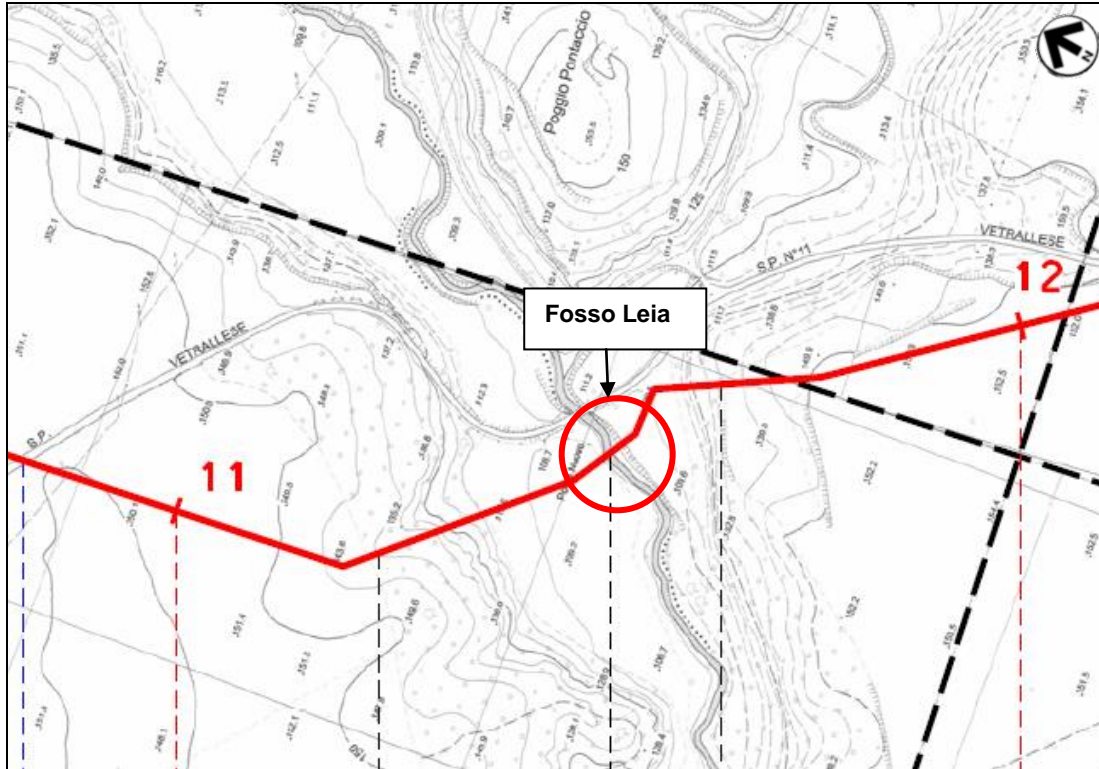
/B – Stralcio planimetrico con localizzazione dell’attraversamento (progr. Km 11+507)
